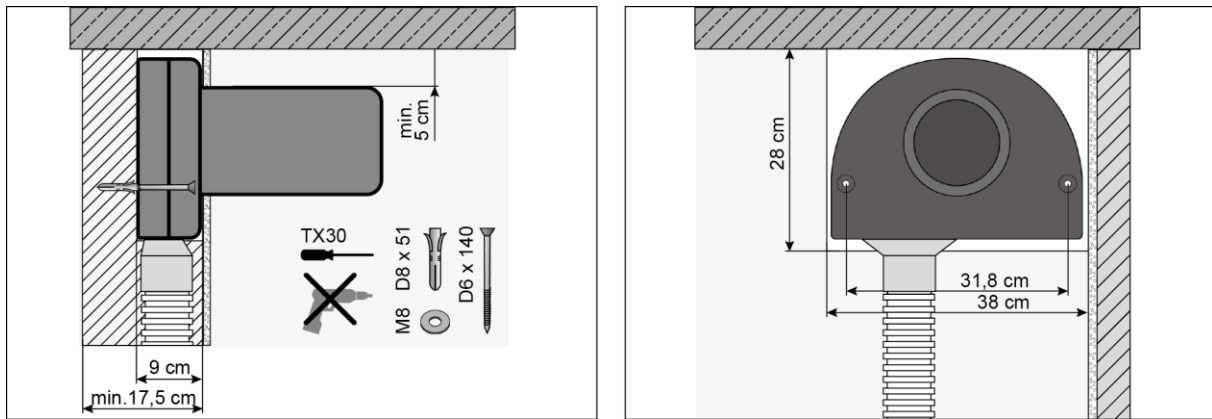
Montage mit Schrauben und Dübeln (Massivbauwand), Seiten- und Frontansicht
